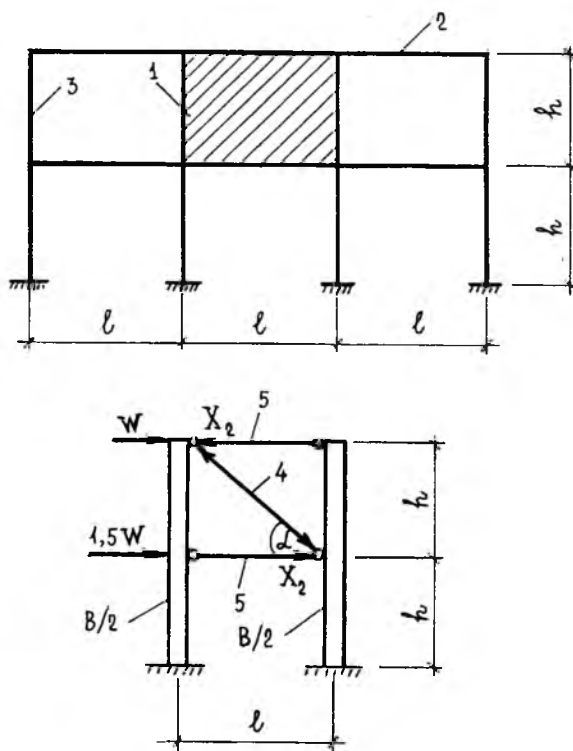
Схема двухэтажного каркасного здания, усиленного стенкой жесткости (1) в среднем пролете (а) и основная расчетная схема (б)
